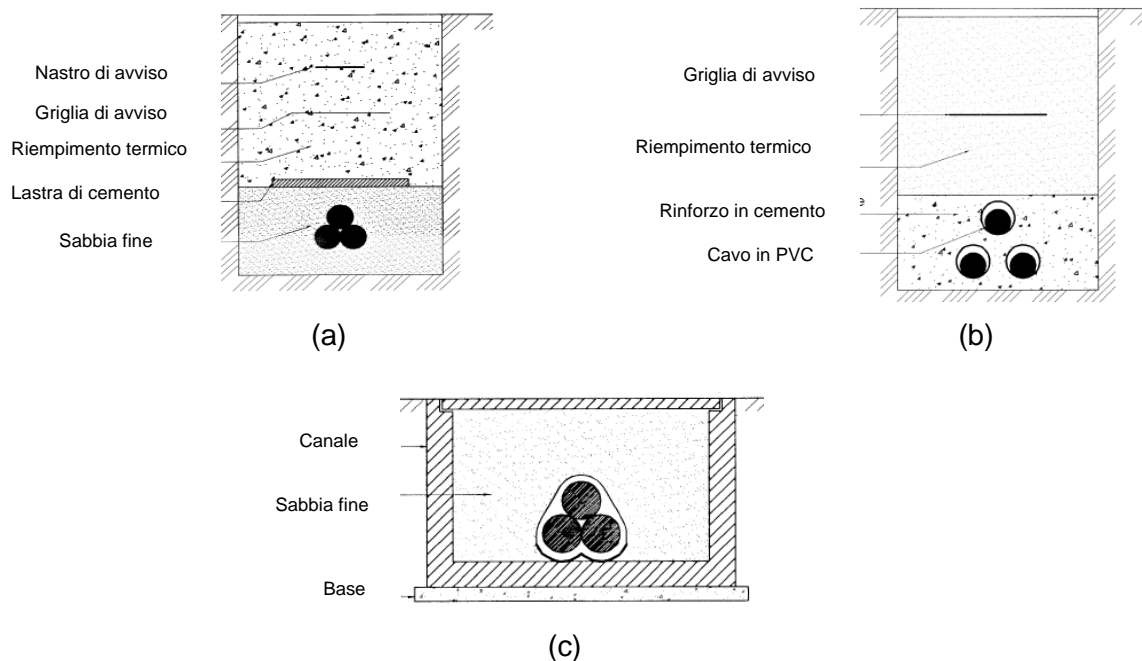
Possibile configurazione di installazione del cavo : a) direttamente interrato; b) installazione per attraversamento stradale; c) posa in condotto (Fonte: “60-500 kV High Voltage Underground Power Cables” –Nexans)
